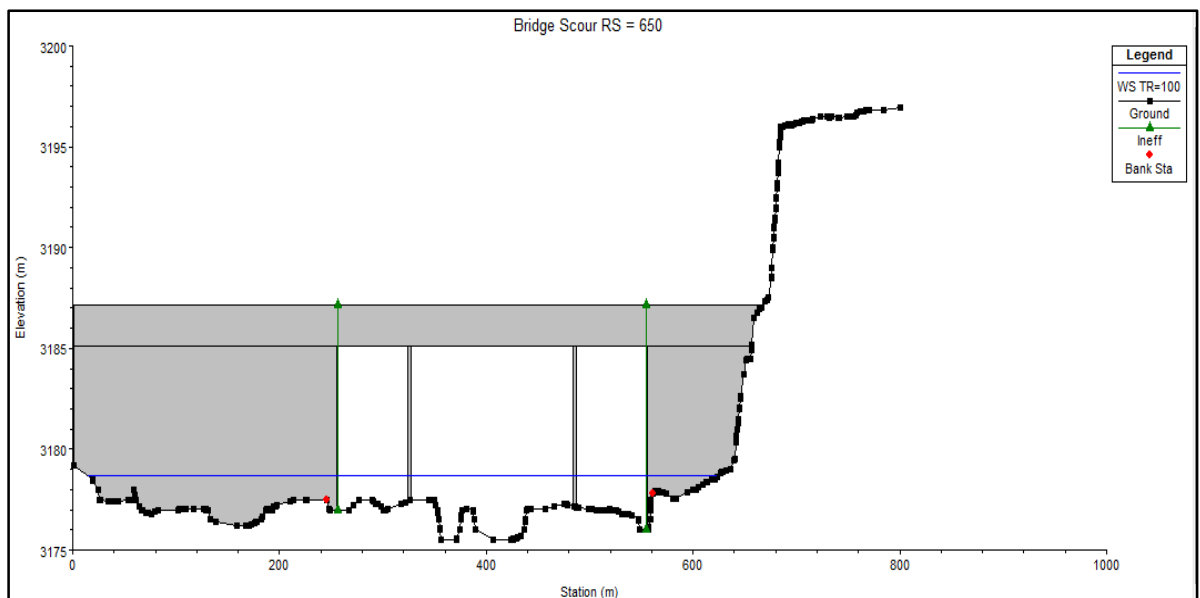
Sección transversal del cauce a la altura del puente donde se ve el detalle del pilar, los estribos y la superestructura. $Tr=100$ años
